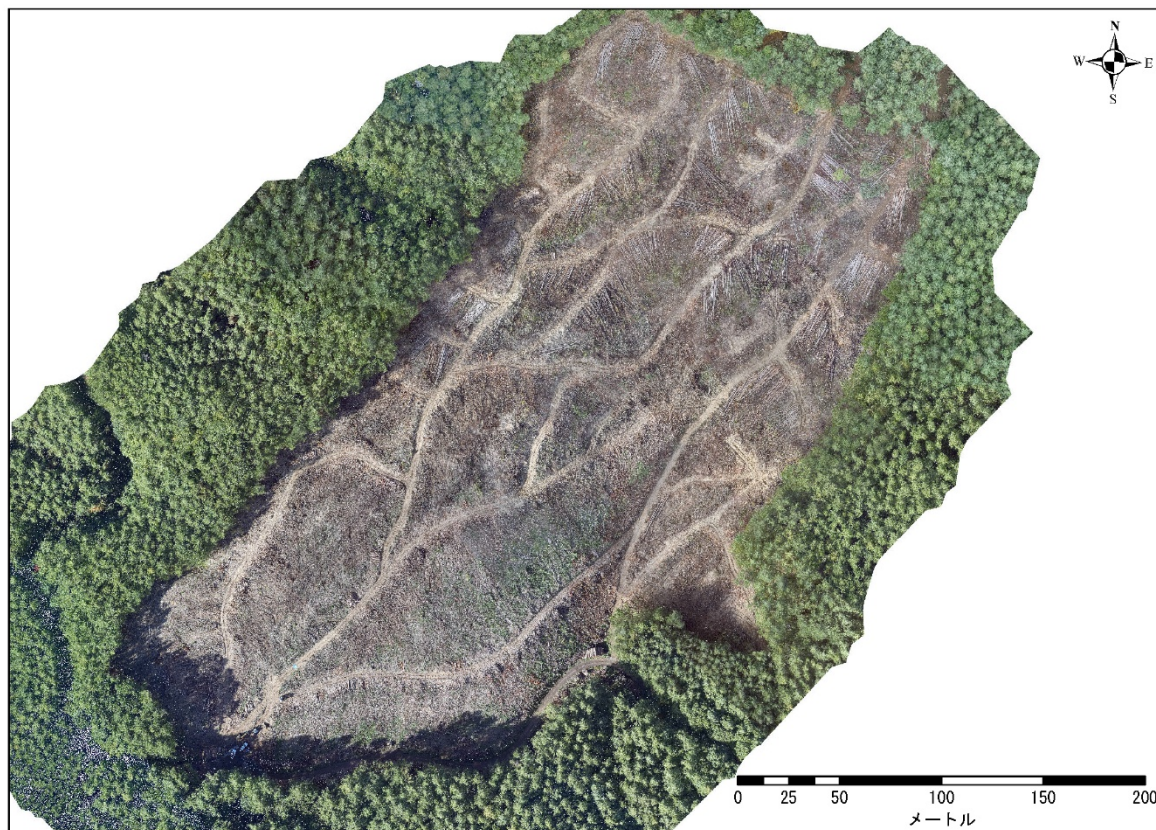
施工前（皆伐地全域） 2025.10.14 ドローン撮影
